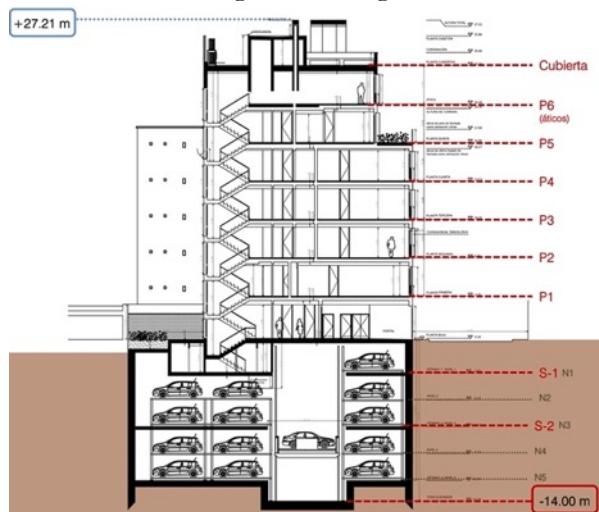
Sección del edificio transversal a la fachada e indicación de niveles.
